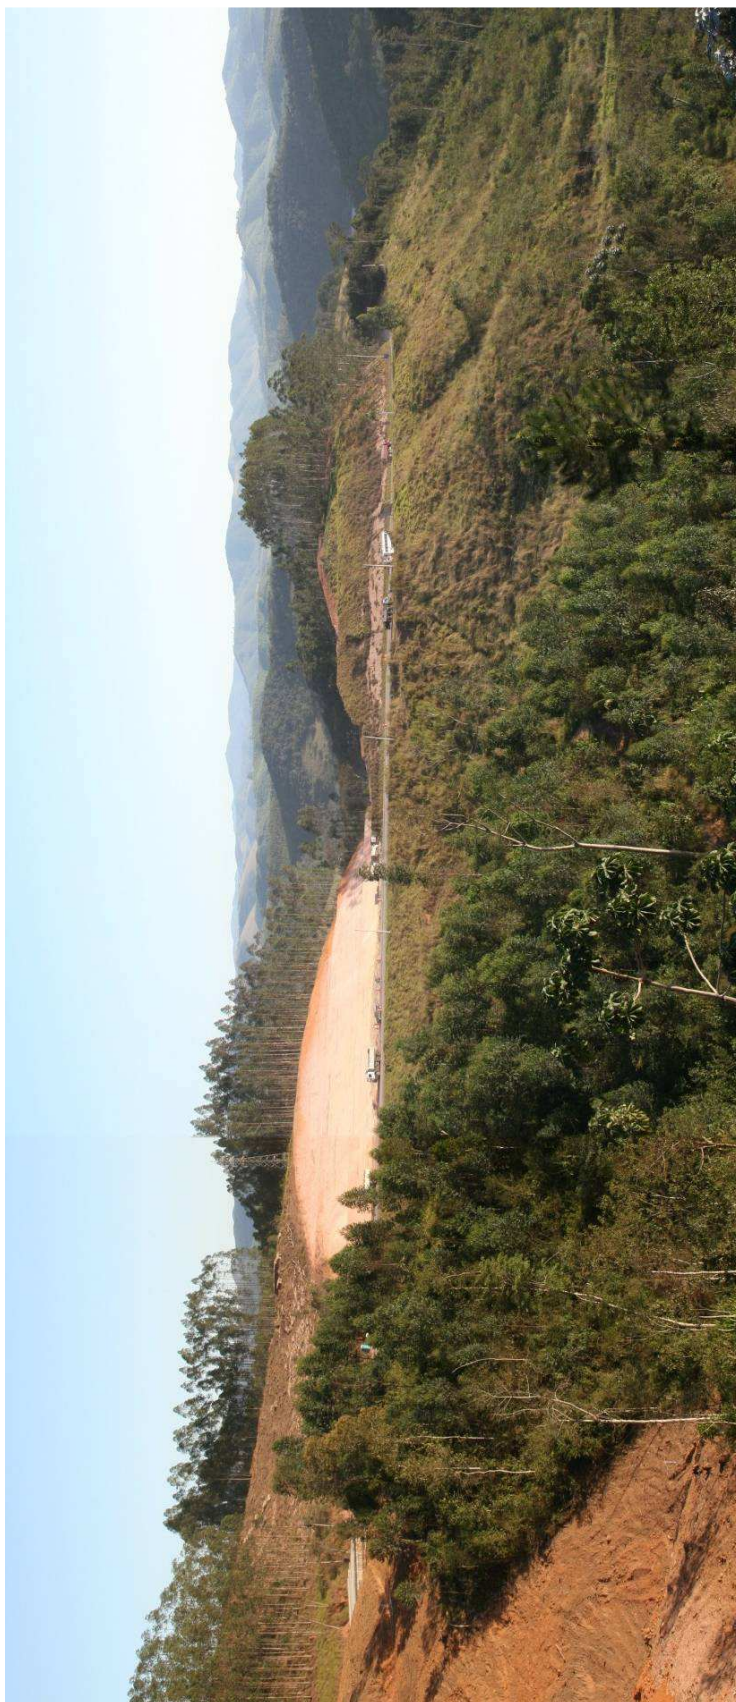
Visão geral das obras de duplicação – novo traçado de pista – km 26,6
